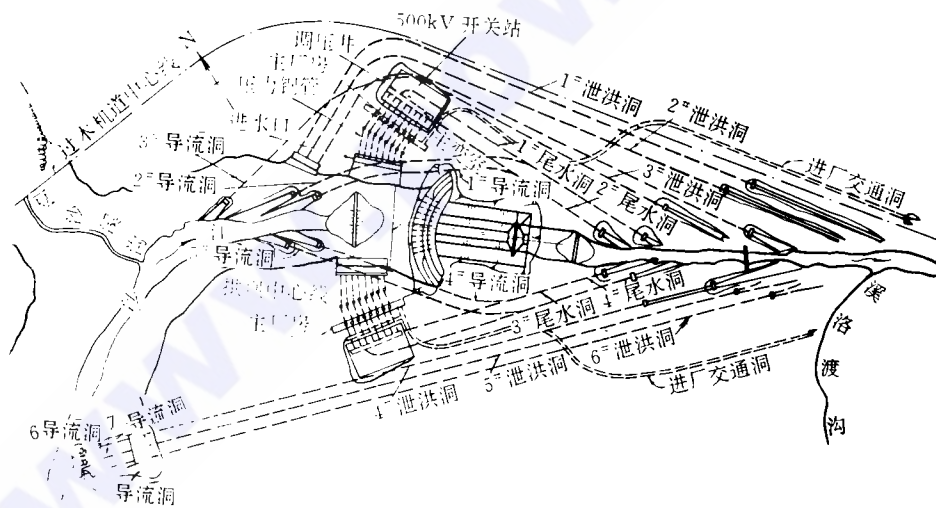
重力拱坝方案 I 坝线枢纽平面布置图
